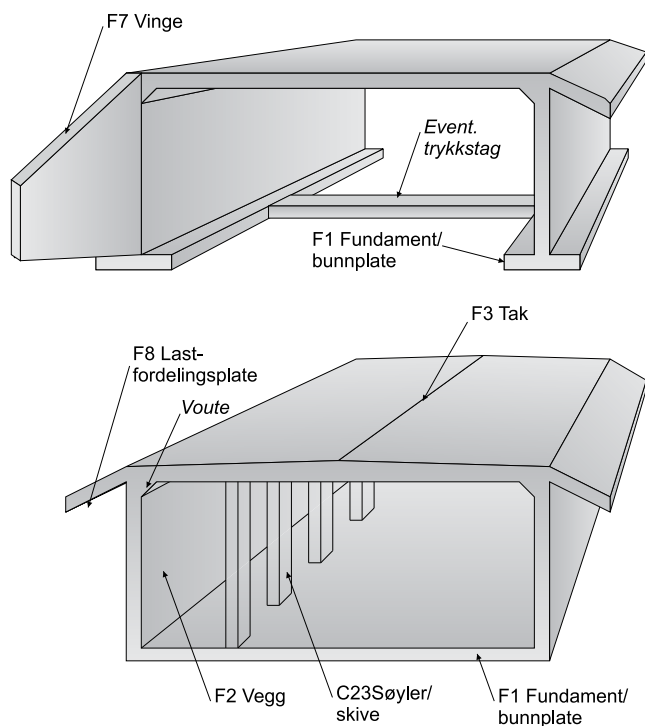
Element F Konstruksjoner i fylling, kulvert med Underelementer
